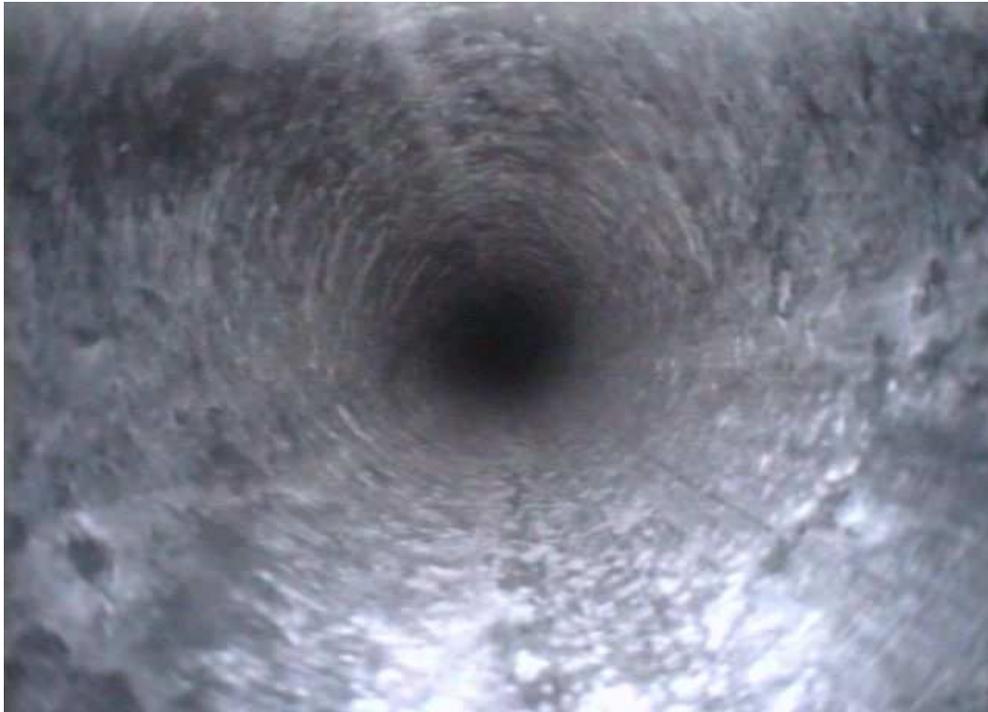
Kleiner Riss im Westen bei 14,30 m
